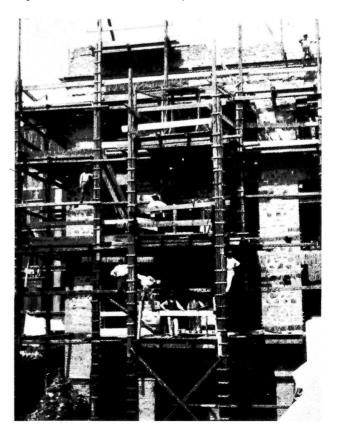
Cantiere tradizionale negli U.S.A. alla fine del XIX secolo.
